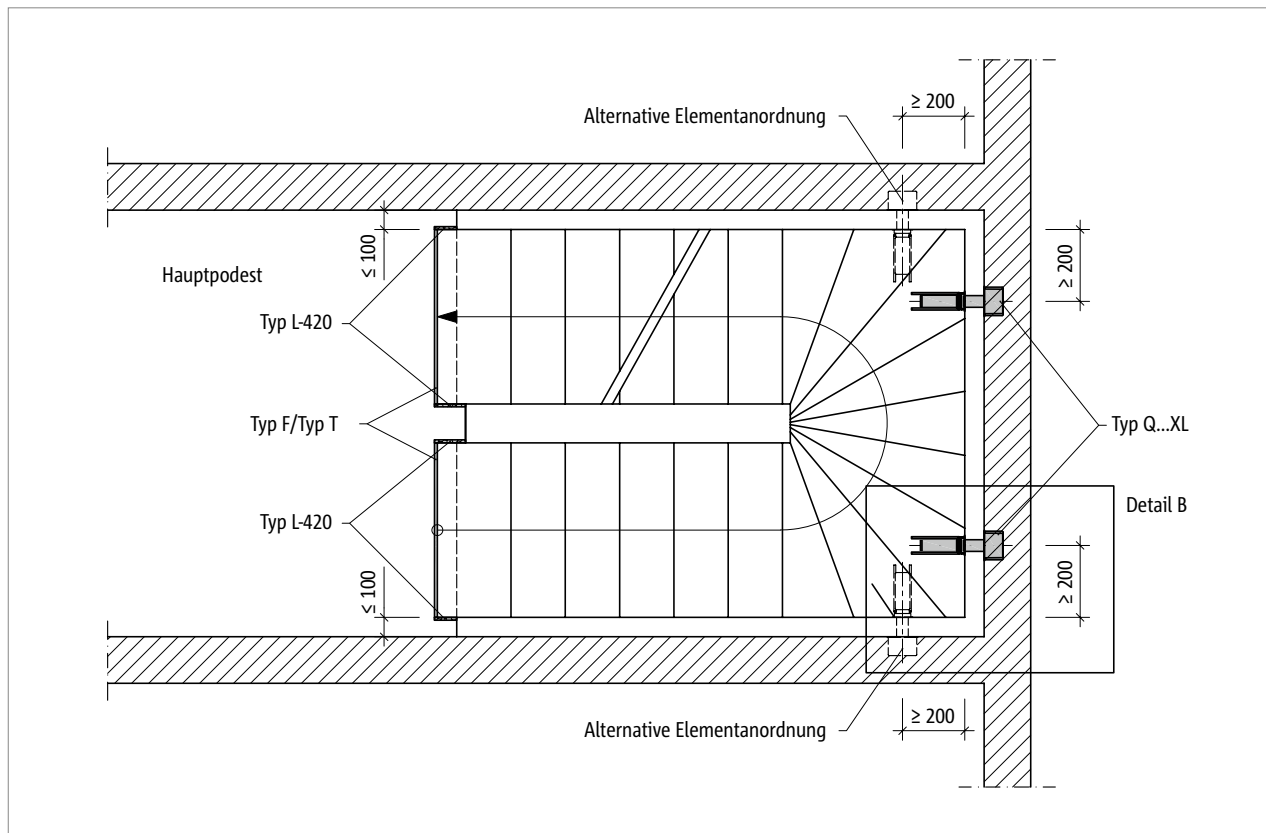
Schöck Tronsole® Typ Q...XL: Elementanordnung im Grundriss bei einer Fugenbreite von maximal 100 mm
